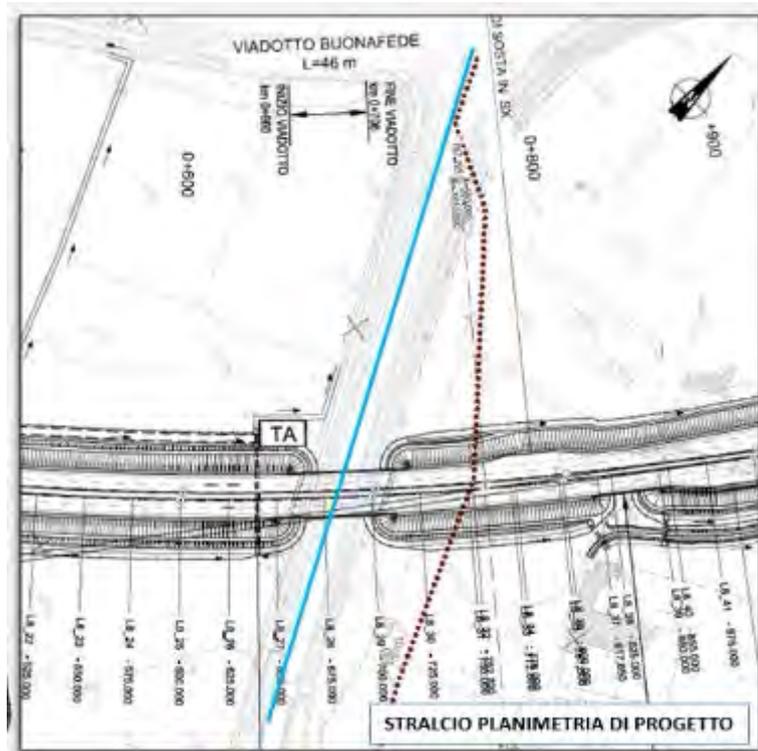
Lotto 8 Ponte sul Fosso Buonafede – Stralcio Planimetrico
